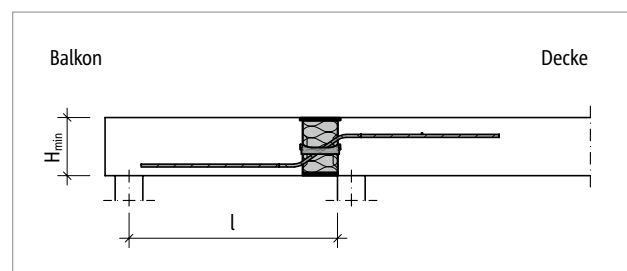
Schöck Isokorb® XT Typ QL: Statisches System (XT Typ QL-V5 bis V8)
